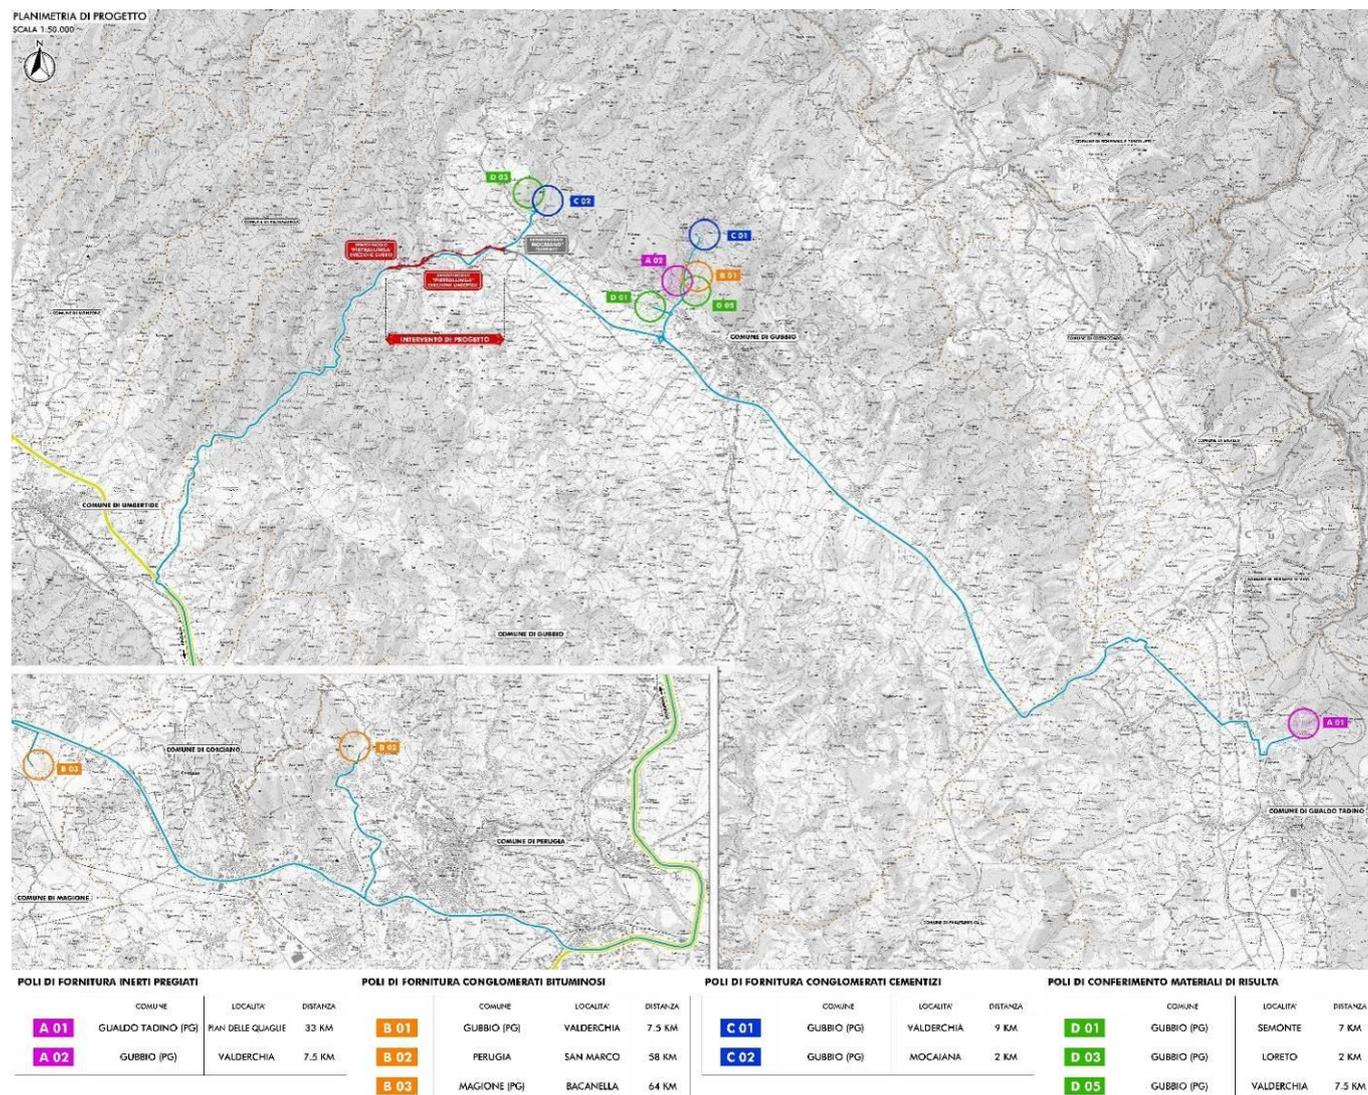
PLANIMETRIA CON INDICAZIONI DEI PERCORSI DI CANTIERE (ESTRATTO DALL'ELAB. T00CA00CANCO01A)
